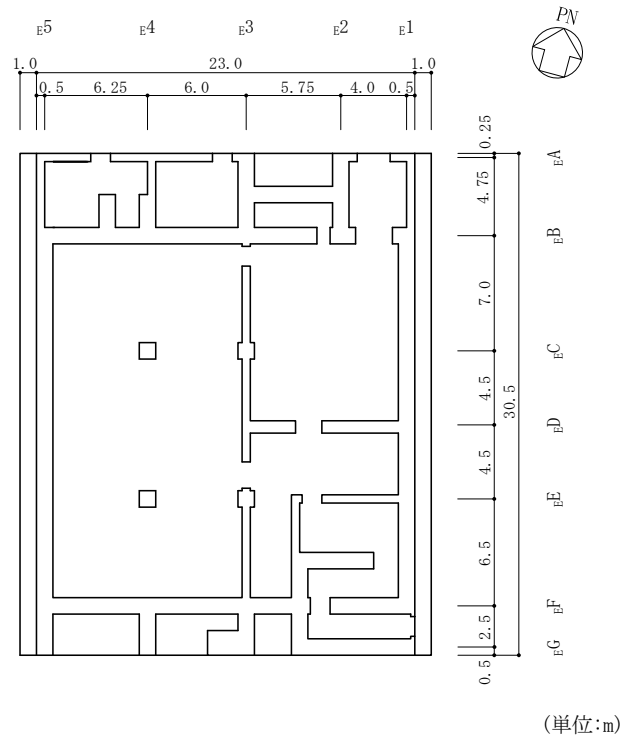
(1) 緊急時対策所の概略平面図 (EL 50.25m)
